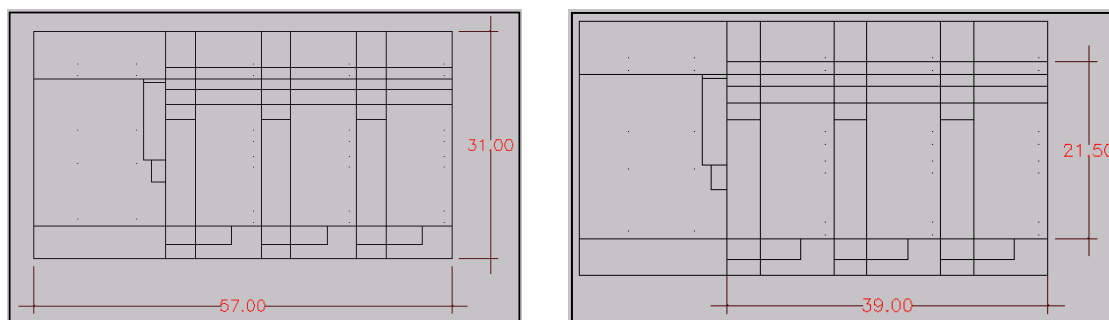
Dimensões da planta geral (à esquerda) e dimensões da planta da torre (à direita).
